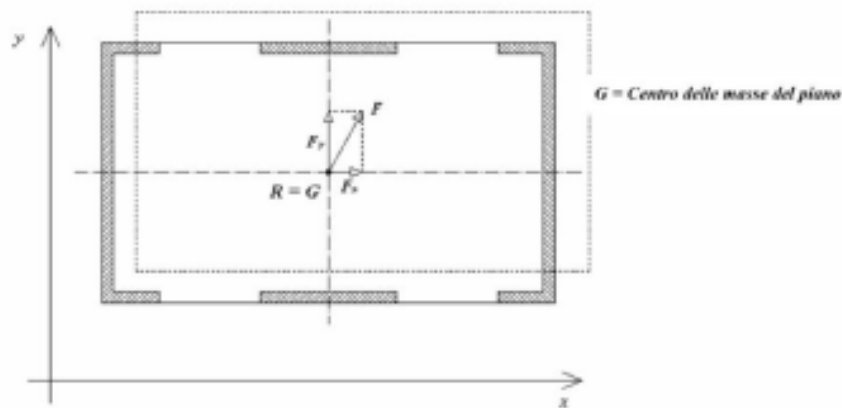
Sistema spaziale di controventamento geometricamente simmetrico in pianta
